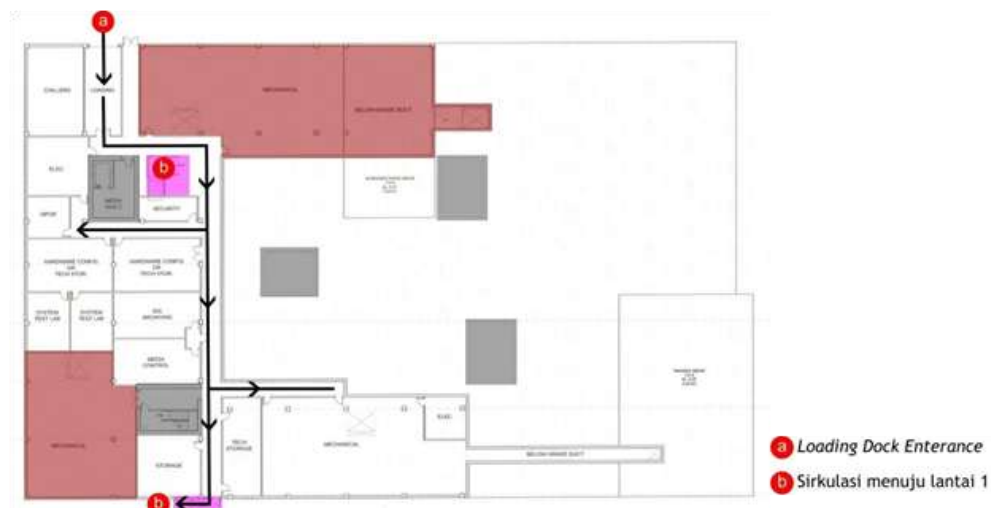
26 Detail Penzoningan Denah Lantai 2
